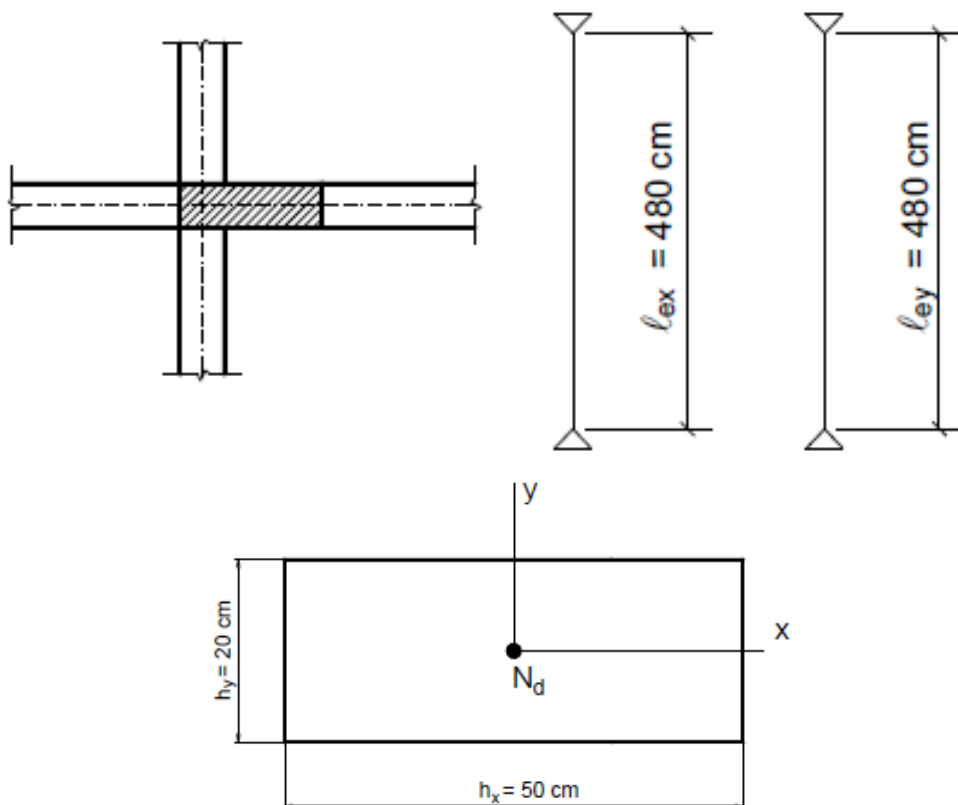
Posição do pilar em relação às vigas, vínculos na base e no topo nas direções x e y , dimensões da seção transversal e situação de projeto
